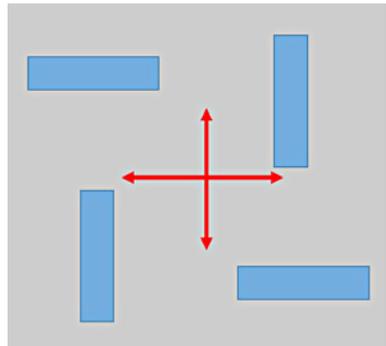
Um 90° versetzte Kantholzstapel (Grundriss)
